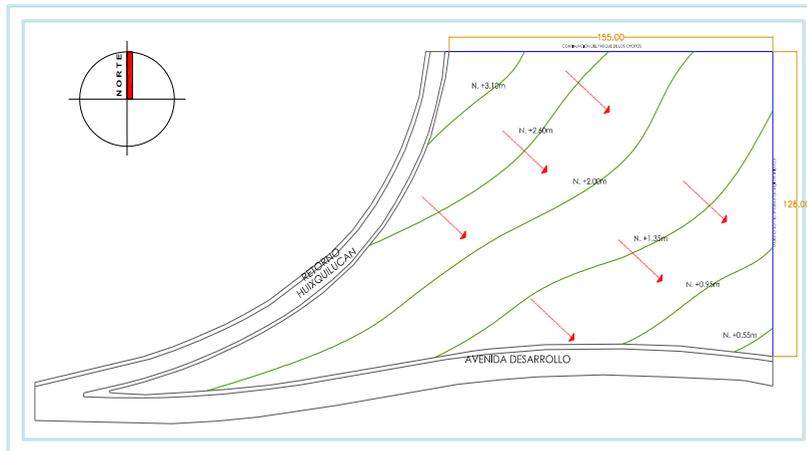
PLANO DE ESCURRIMIENTO EN EL TERRENO
